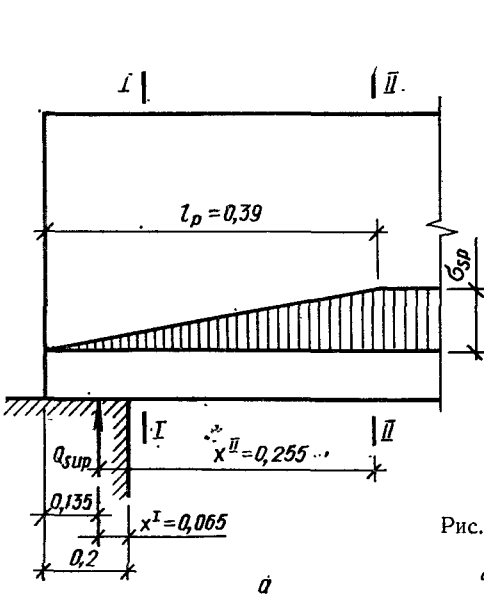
Предварительно напряженная плита перекрытия (размеры в м):
